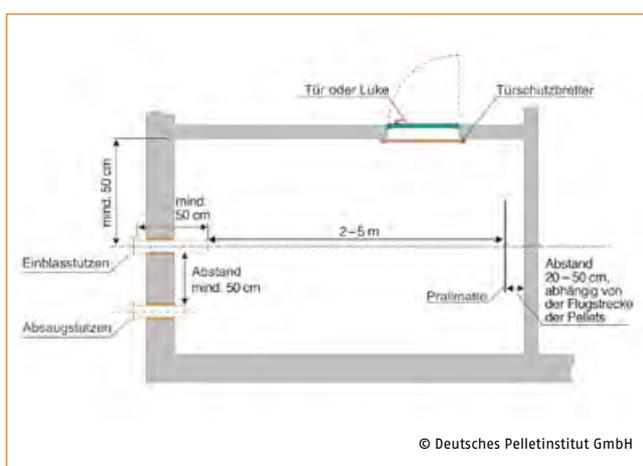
Grundriss eines Pelletlagerraums (Lüftung über Befüllsystem)
